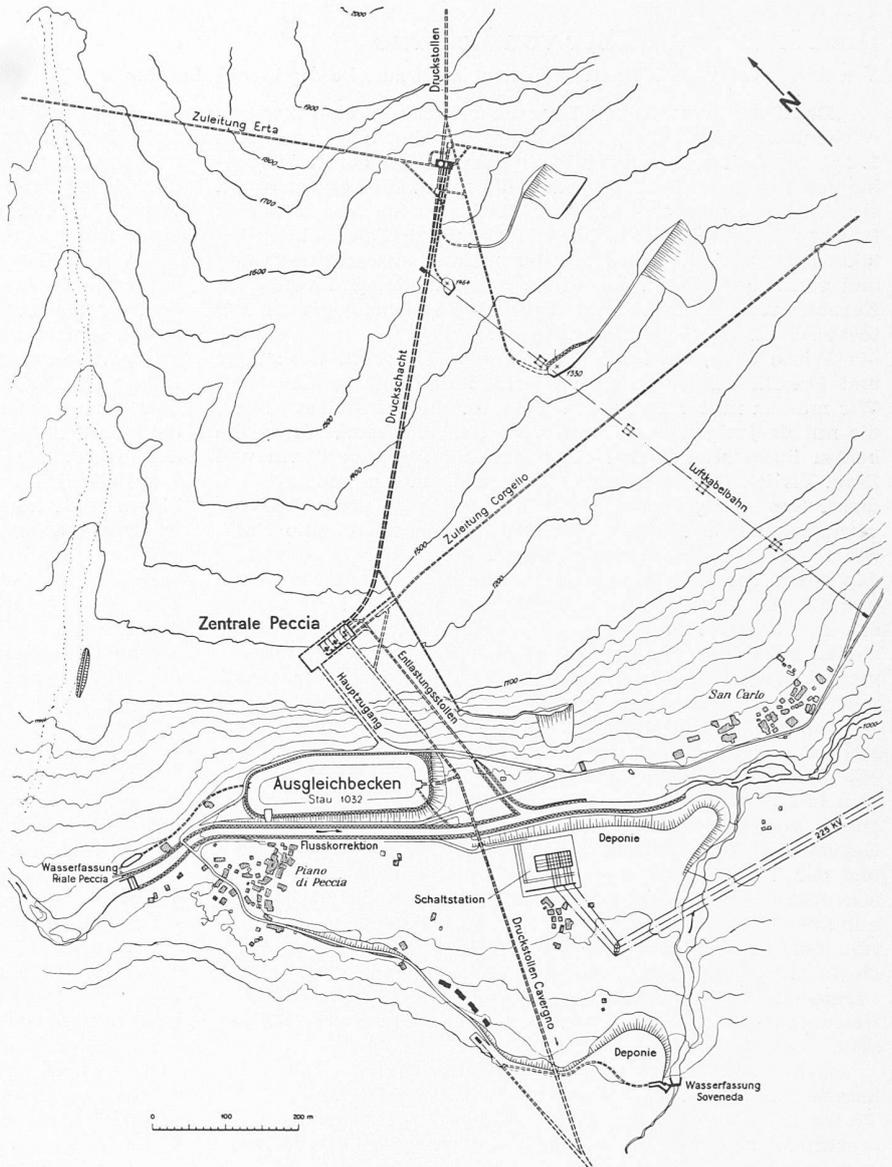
Wasserschloss, Druckschacht und Zentrale Peccia, Plan 1:10 000
